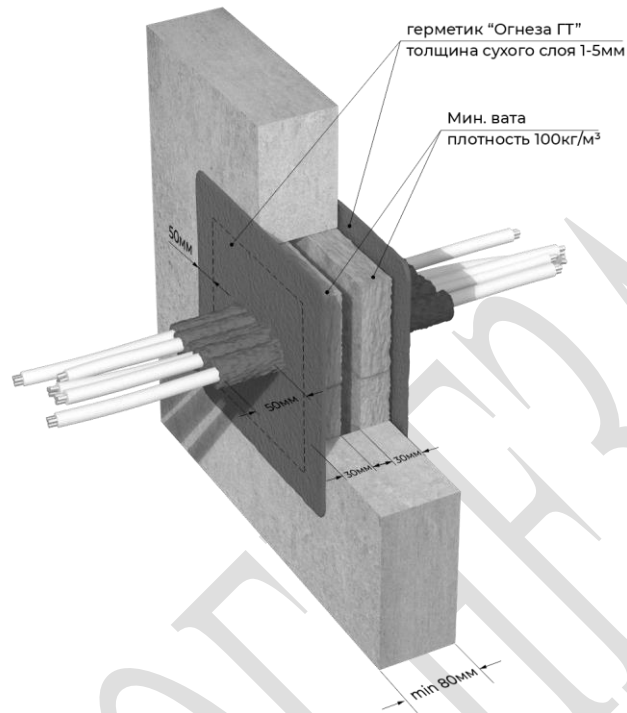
Монтаж кабельной проходки с использованием герметика «ОГНЕЗА-ГТ» для стен и перекрытий толщиной от 80 мм (IET 60)
